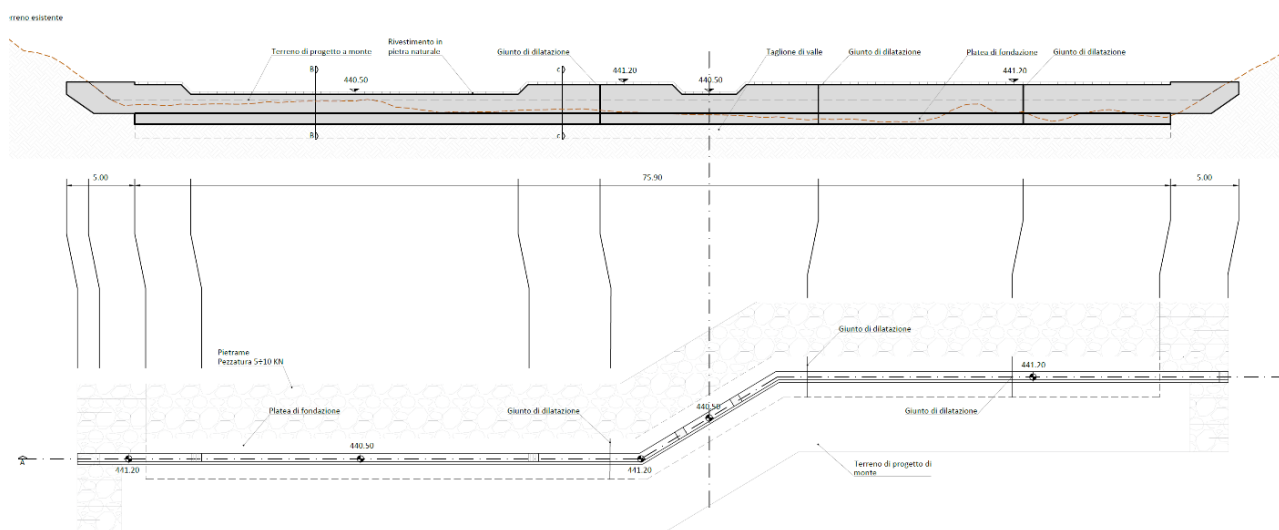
Esempio di briglia composta: briglia di monte M\_1. Prospetto (in alto) e planimetria (in basso).
